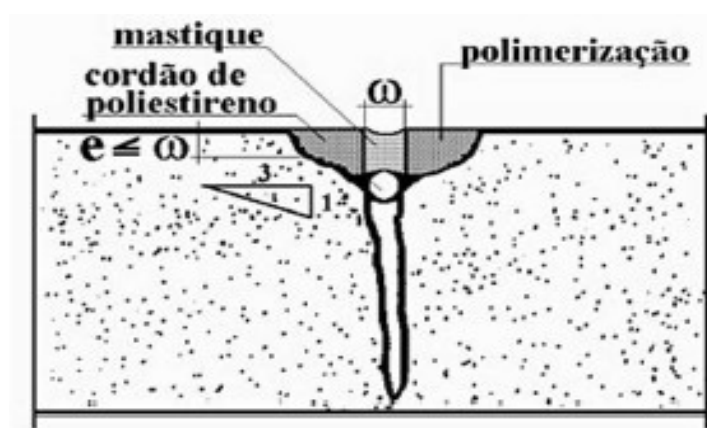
Selagem de fissuras utilizando-se mastique (resina vedativa).
